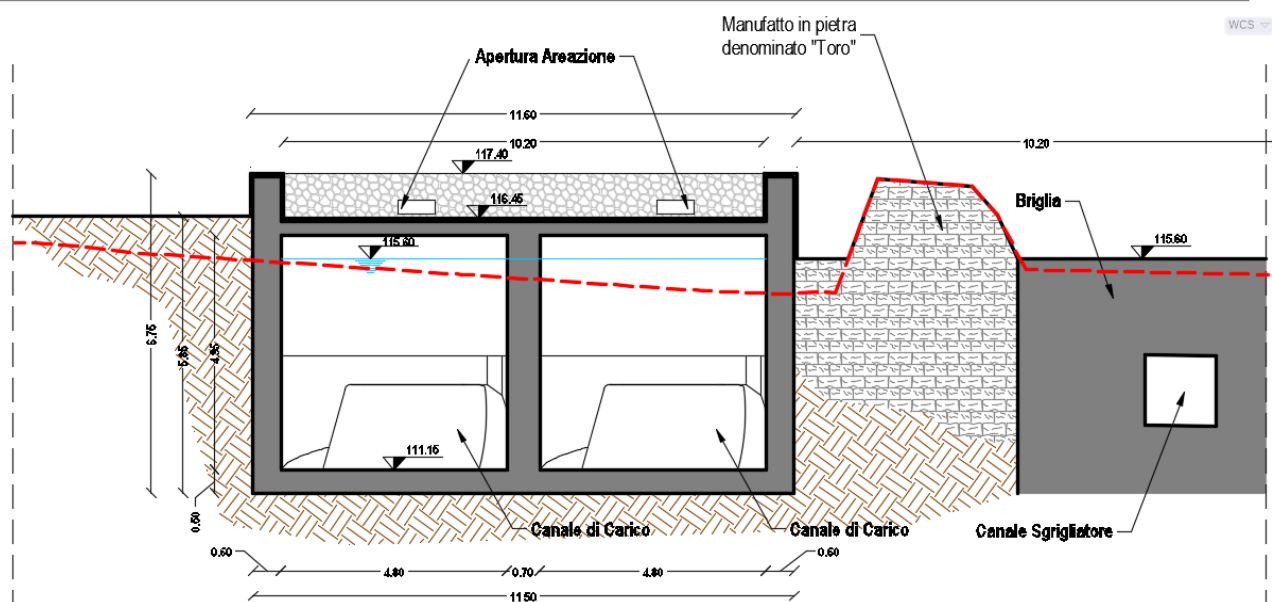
VISTA IN SEZIONE DEI CANALI DI CARICO
